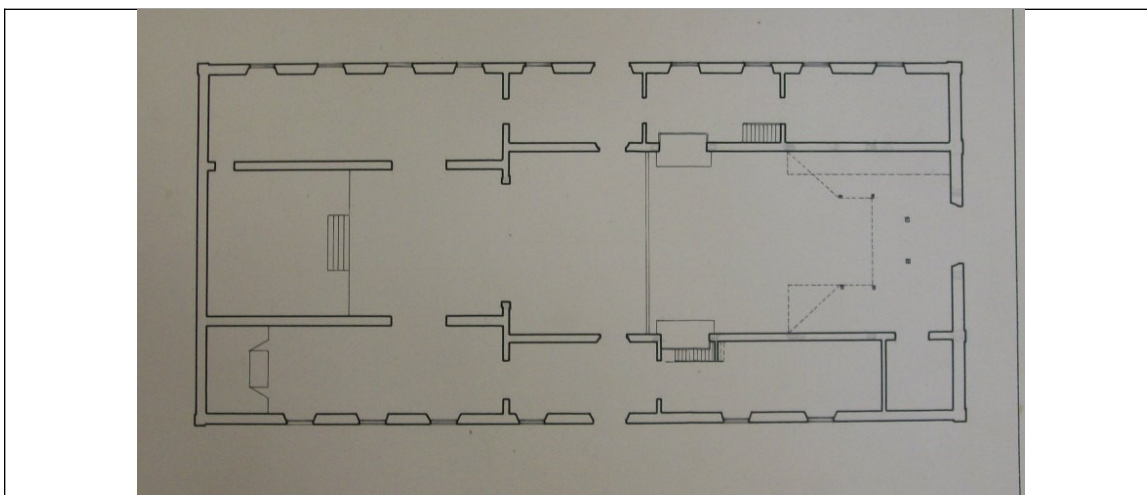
Acima planta da Igreja de Nossa Senhora do Rosário.
